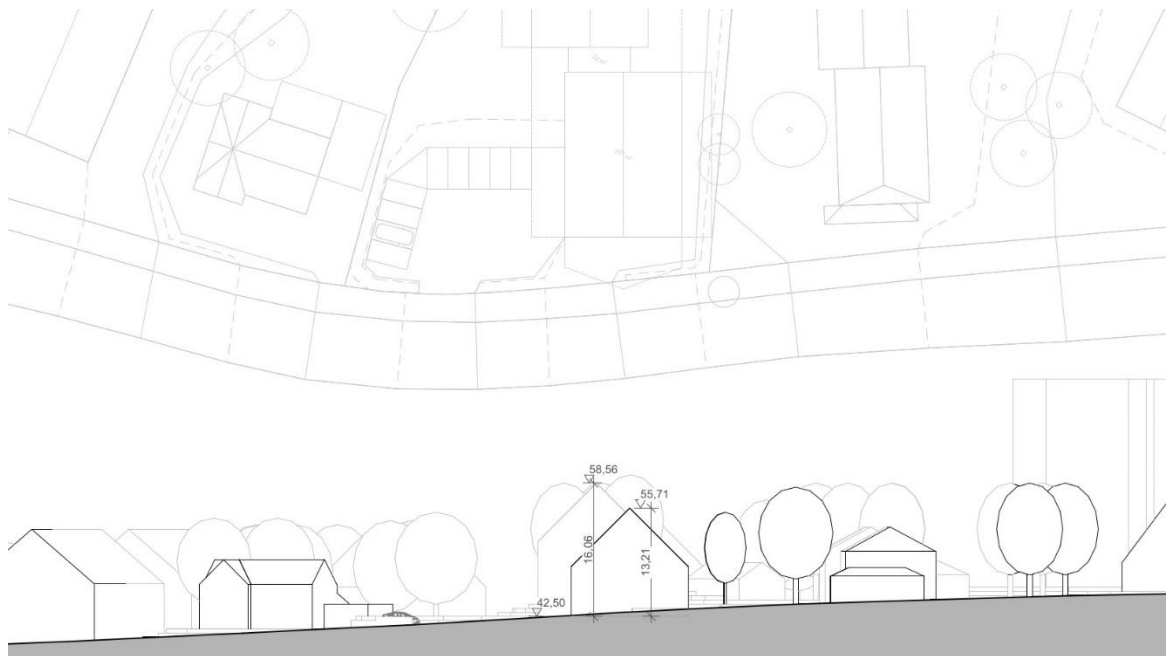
Städtebauliches Konzept „Fördestraße 51“, Straßenschnitt (unmaßstäblich)
